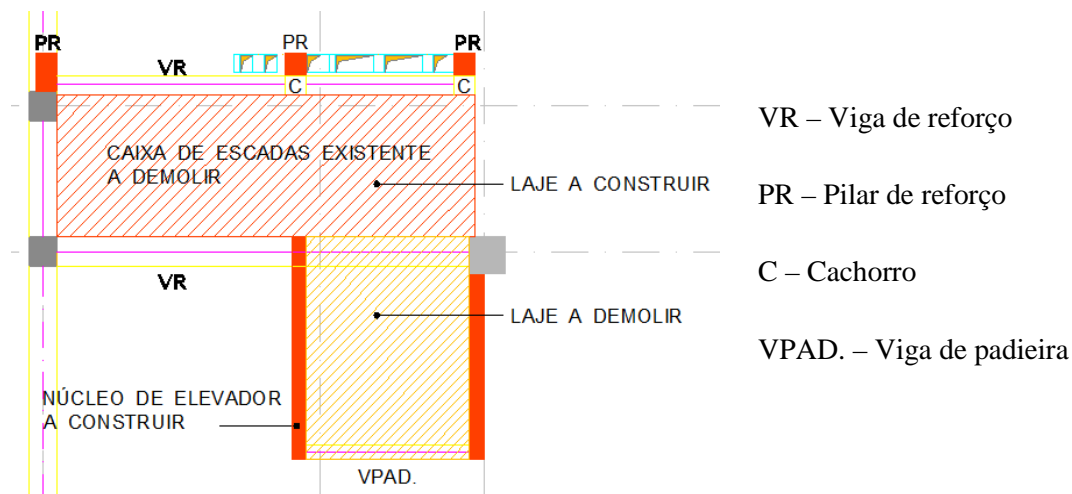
Solução estrutural para fecho da laje na zona do antigo núcleo de escadas (adaptado de [42])
